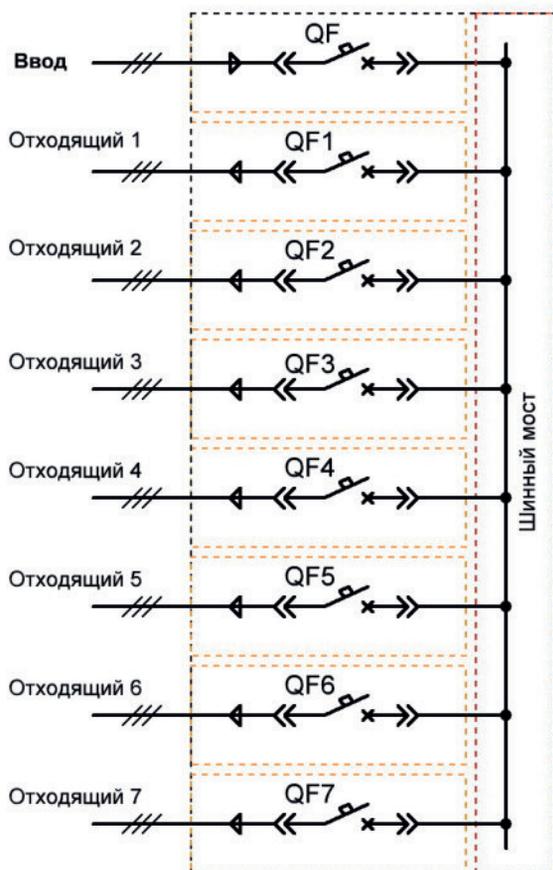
Схема однолинейная ШР-ПП-100...1600А с выдвижными автоматическими выключателями.
